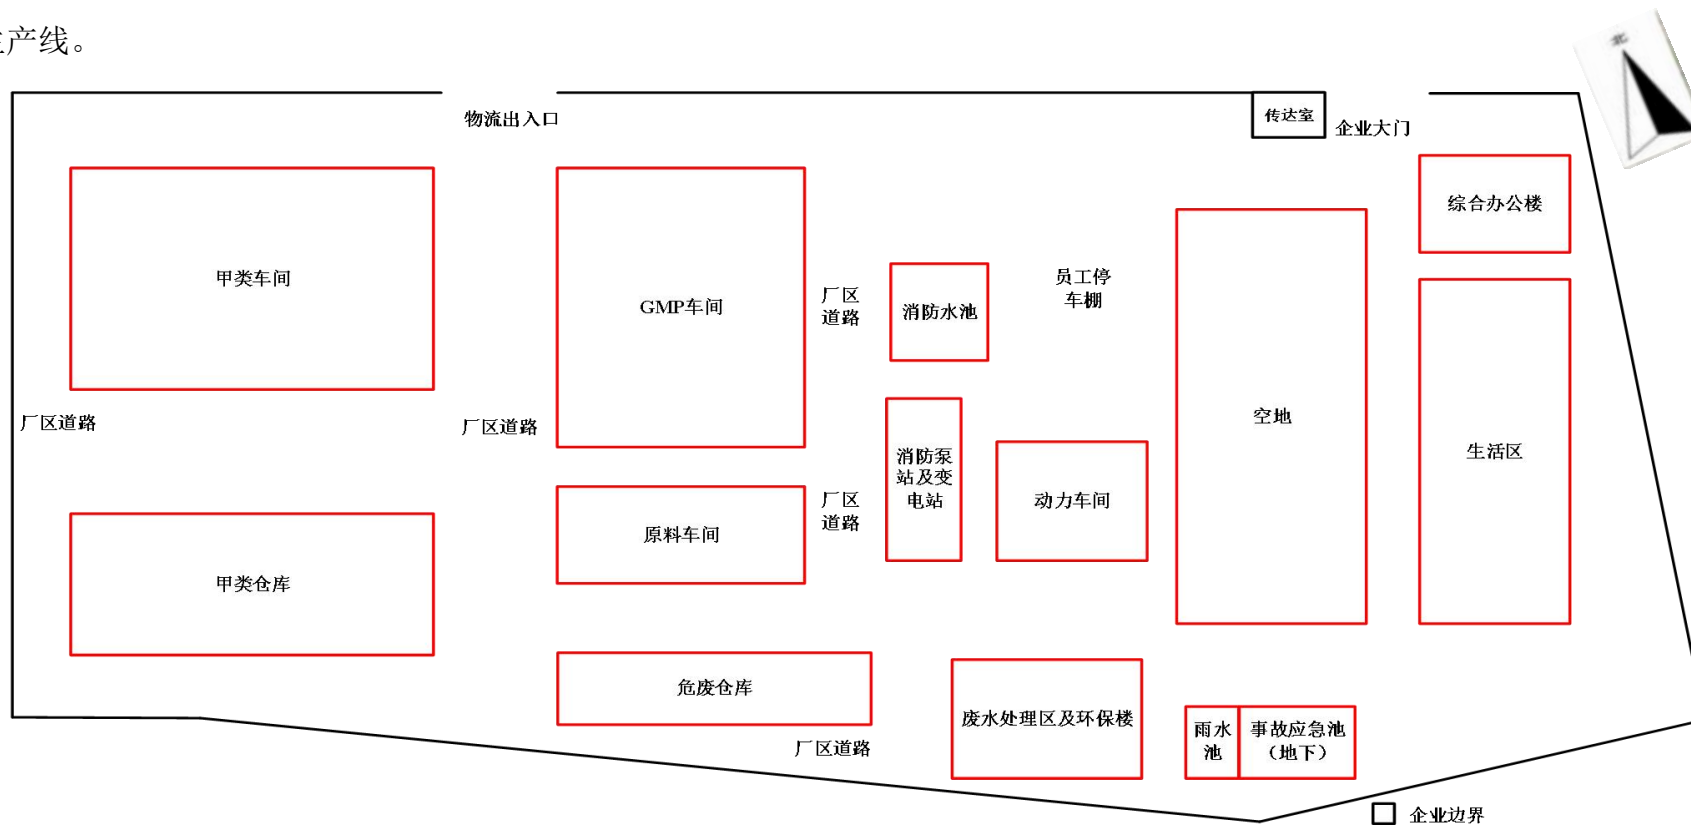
浙江湃肽生物股份有限公司平面布置图
